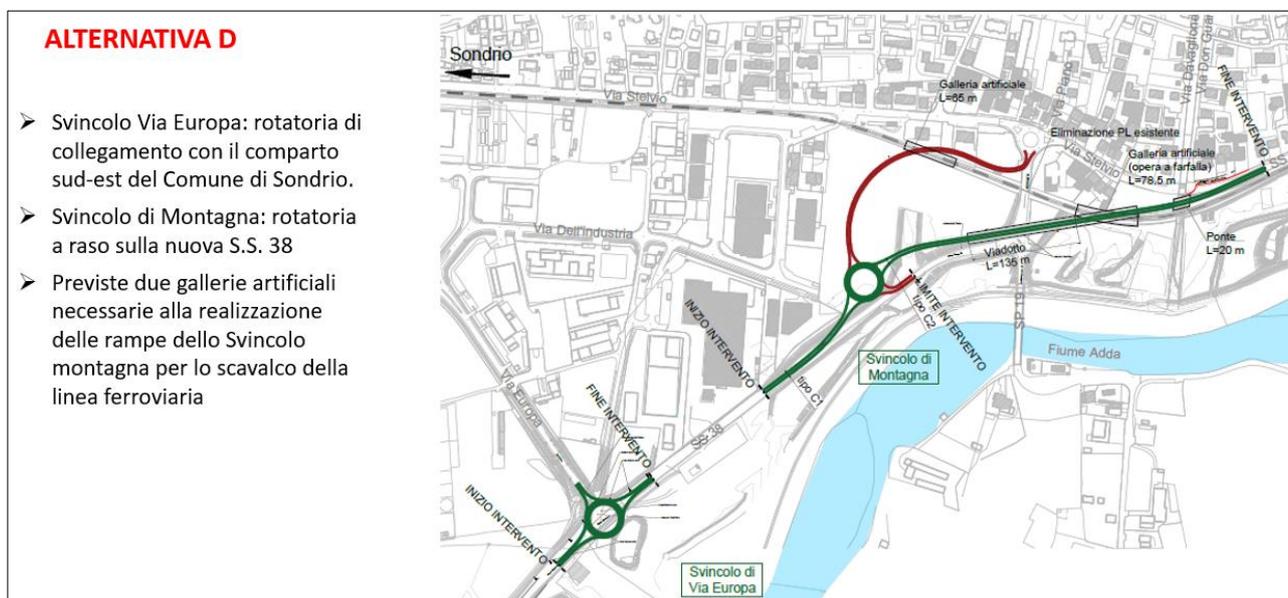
Stralcio planimetrico alternativa D (PFTE)
